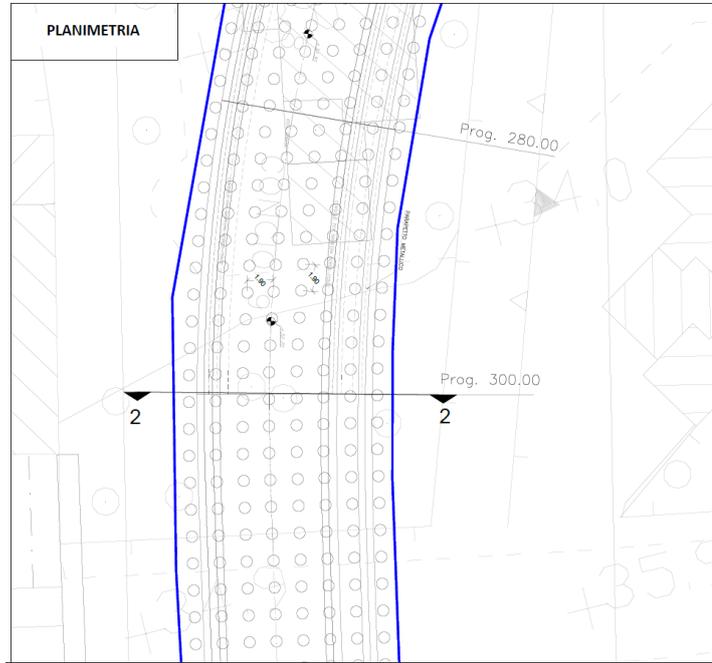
Sezione rappresentativa tratta IV03 – rilevato 2 - planimetria
